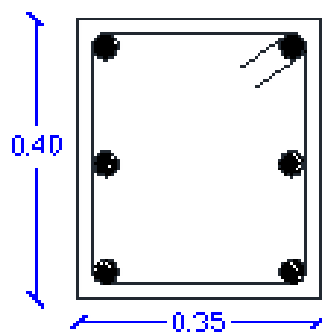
Detalle de distribución de acero en la sección de la columna (Estructura 2).
